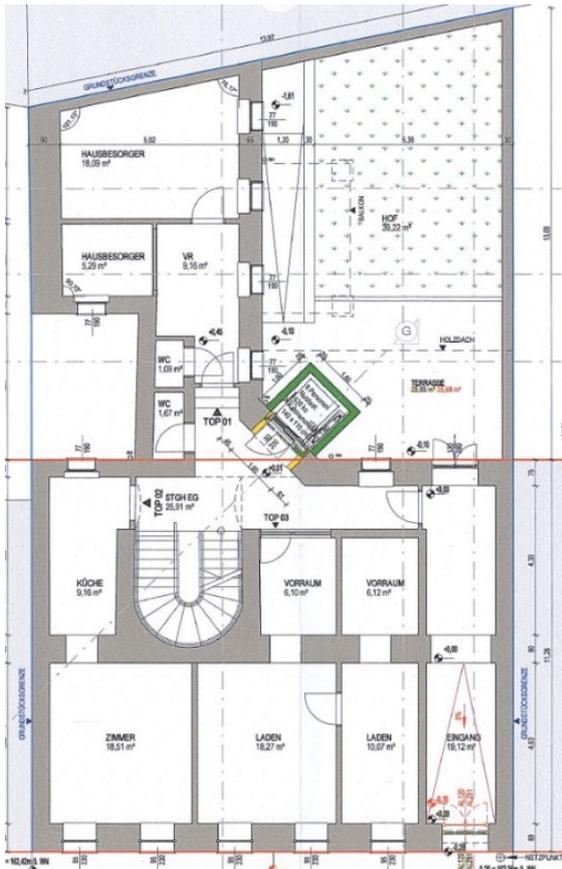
L-Form Grundrisstyp der Frühgründerzeit (links)⁵⁰
